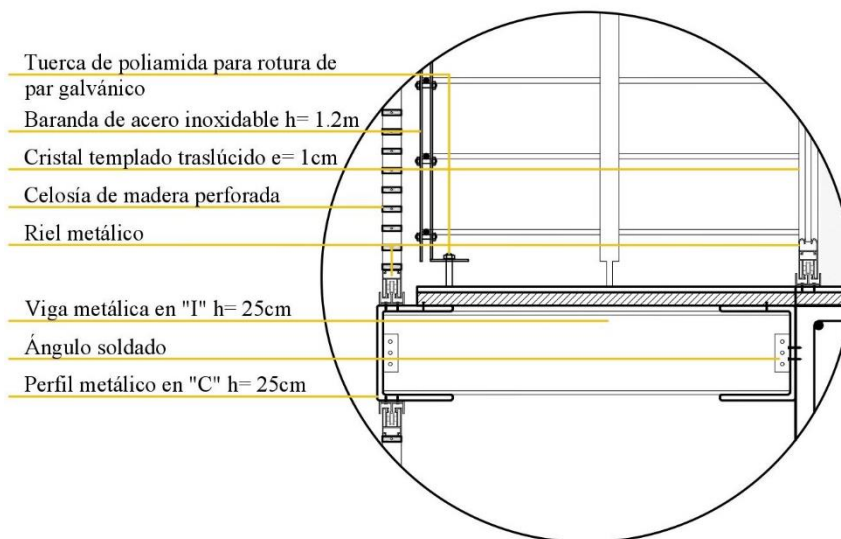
Detalle de cristal templado y celosía de madera perforada. Fuente: Propia
